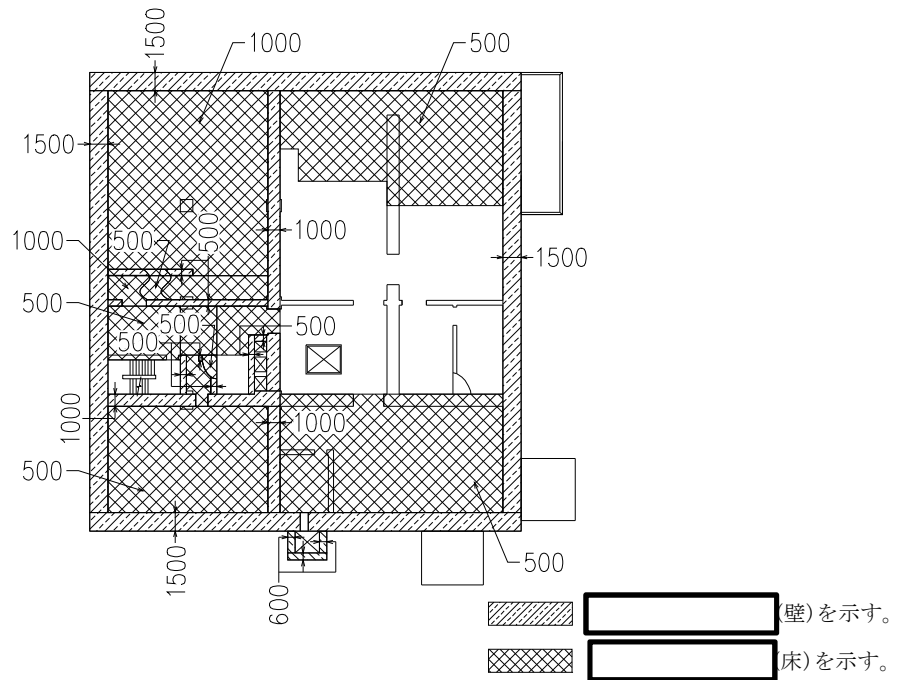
(3/7)  の範囲 (3 階平面図 : EL. 37.0 m)
